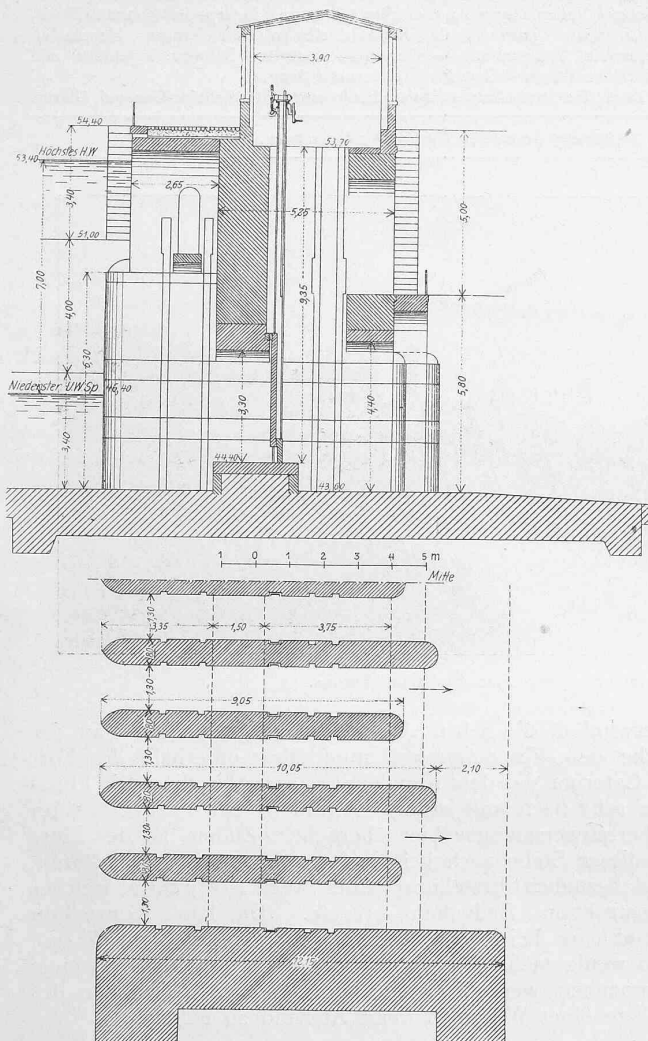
Grundriss und Querschnitt des Kanaleinlaufes. — 1 : 200.
